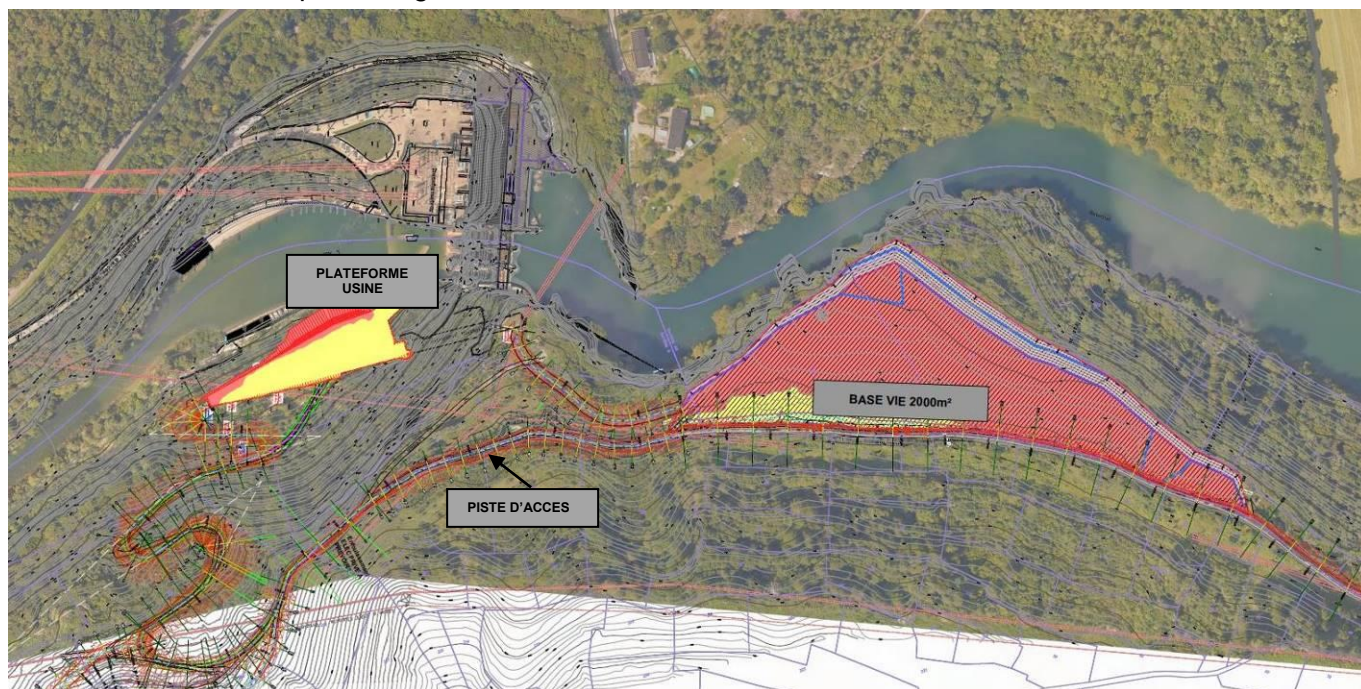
Plan d'ensemble de la zone de chantier et des emprises
